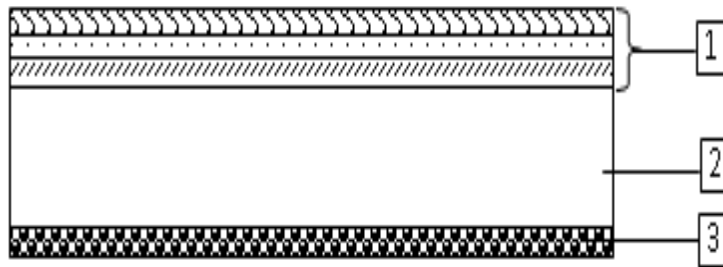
Section transversale d'un plancher à dalle pleine.
